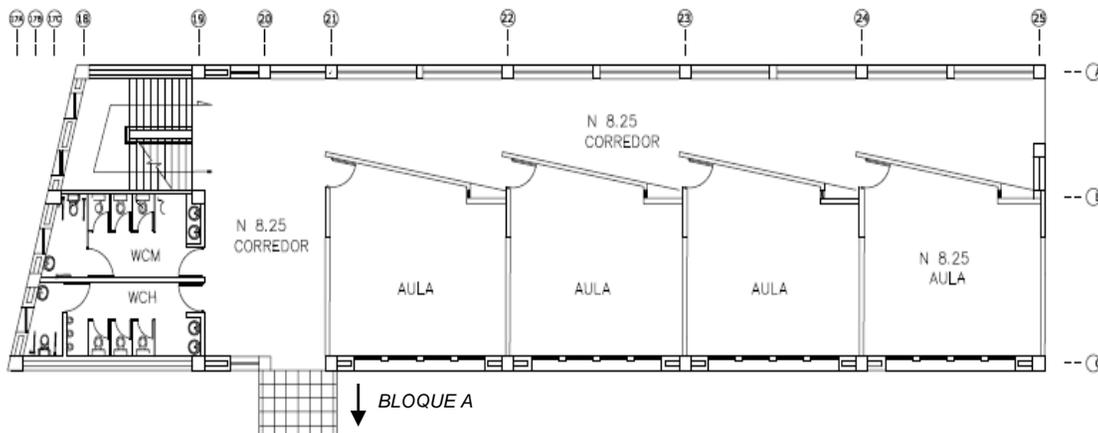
Distribución arquitectónica vista en planta Bloque B
